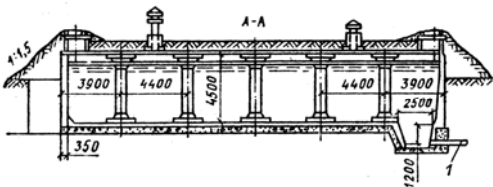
Конструкция резервуара цилиндрической формы:
